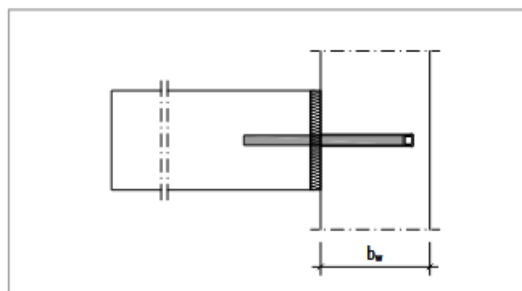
Schöck Stacon® Typ LD: Minimale Bauteildicke einer Wand oder Stütze
